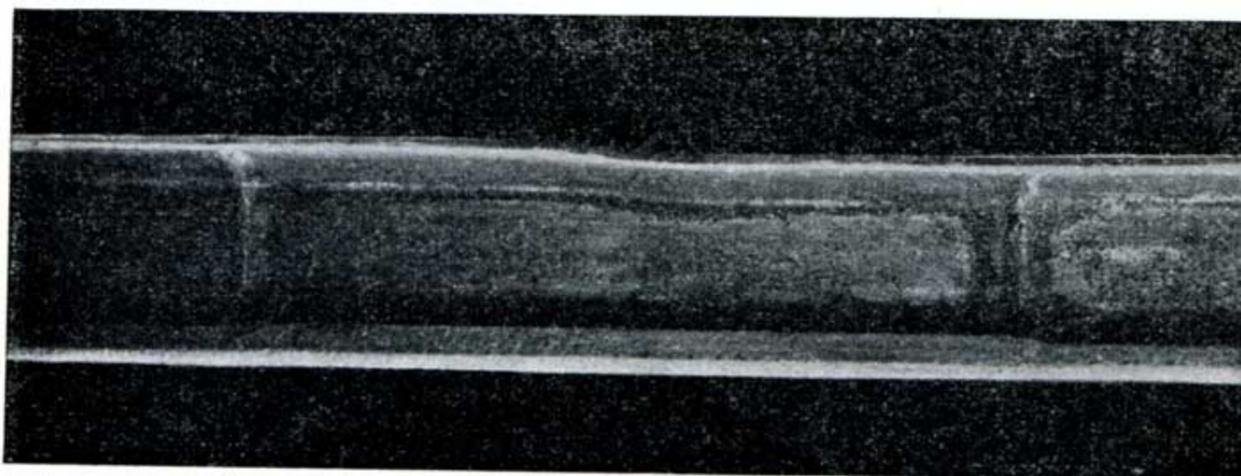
Raccord soudé pour rails de profils différents.
